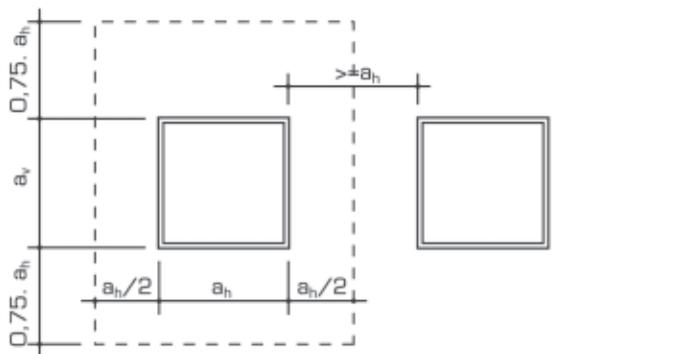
Ilustração de distribuição horizontal de aberturas em uma parede de concreto
